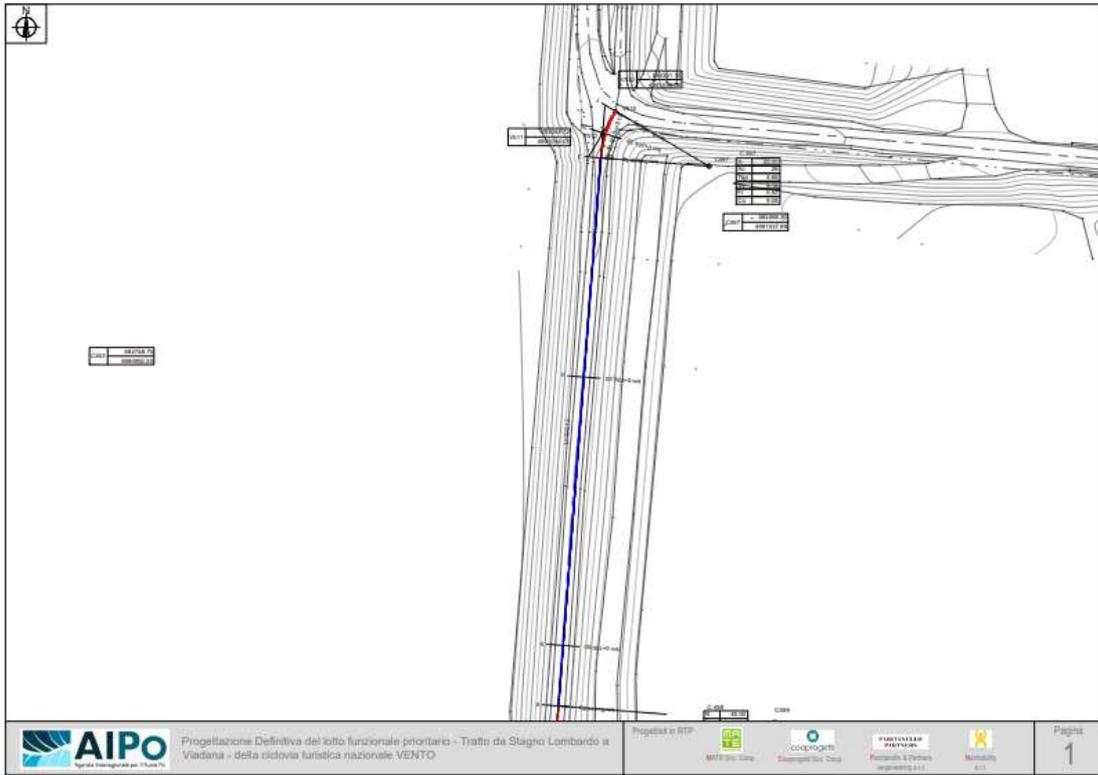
Tavola 1 Planimetria di tracciamento, da progetto MATE
